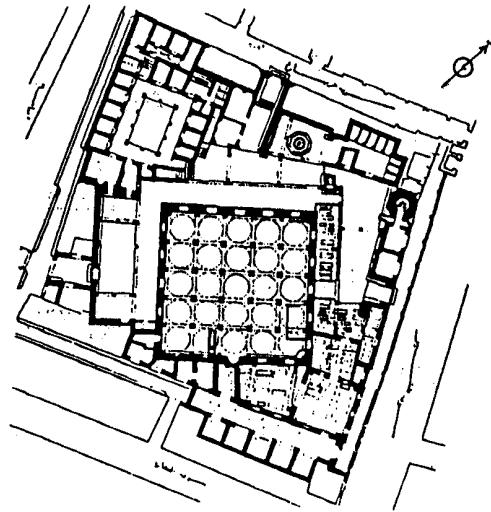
مسقط أفقي لجامع شائب العين محمد باشا بطرابلس الغرب
